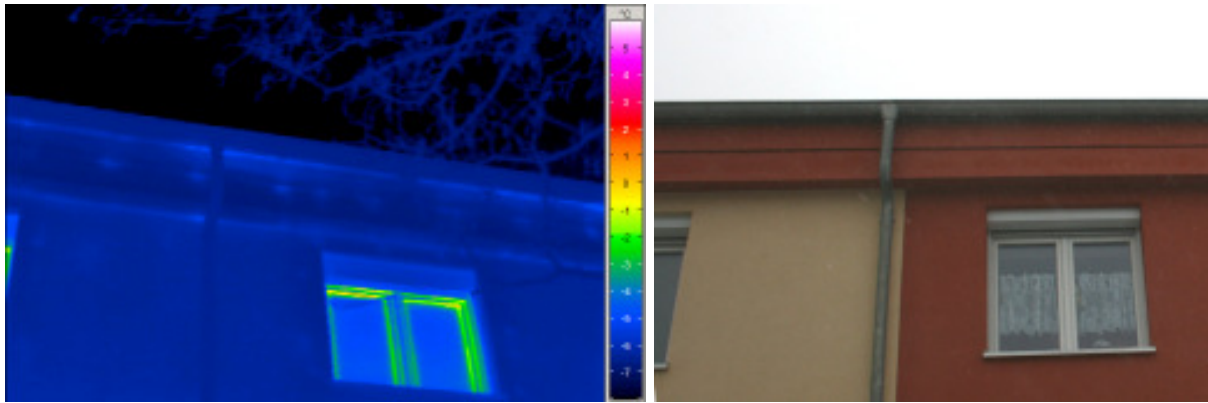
Detail Nordfassade mit Dachüberstand/Traufpunkt vom PHiB.
